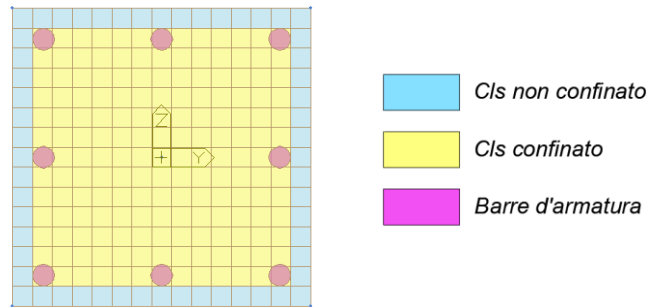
Sezione a fibre PIL_P1 e PIL_P2
